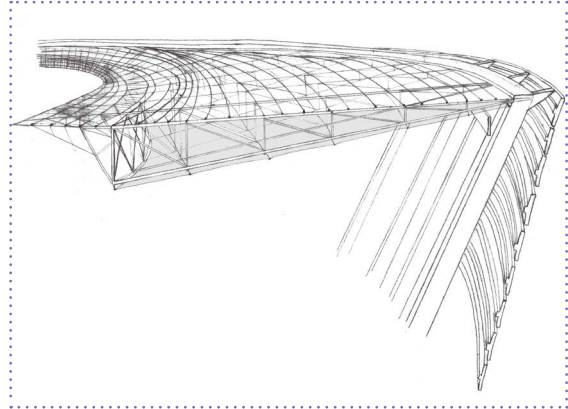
Interior de la cubierta textil del estadio Cape Town
